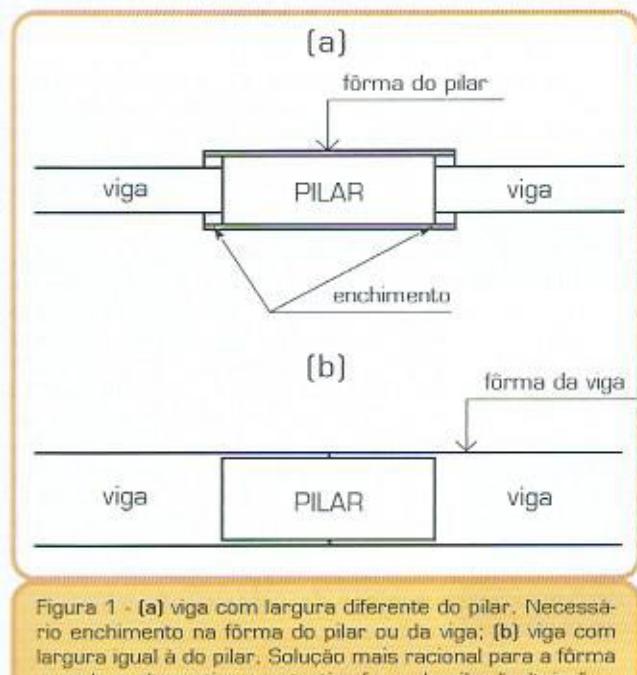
(a) viga com largura diferente do pilar. Necessário enchimento na fórmula do pilar ou da viga; (b) viga com largura igual à do pilar. Solução mais racional para a fórmula quando a alternativa construtiva for a de pilar "solteiro".
